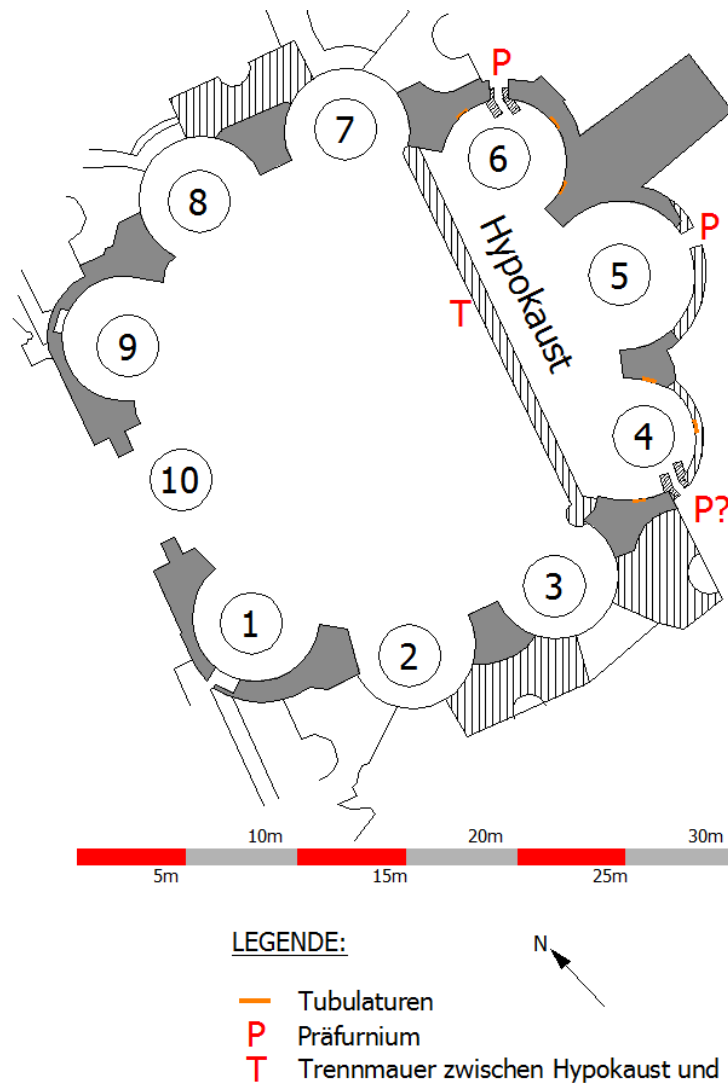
Rom, Tempio di Minerva Medica; vereinfachter Grundriss des Kernbaus.
